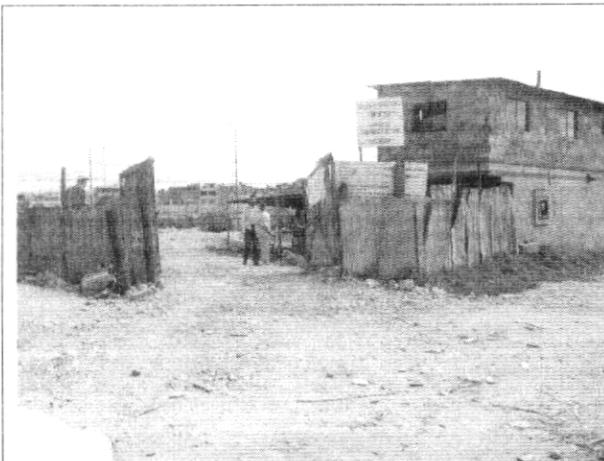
Acceso actual al predio, se observa la construcción de dos pisos en mampostería sin confinar.
